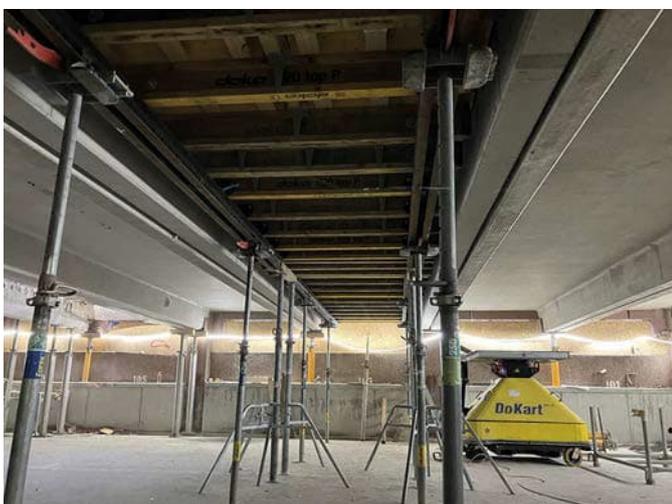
Platzierung und Montage der neuen 16m langen Spannbetonträger
